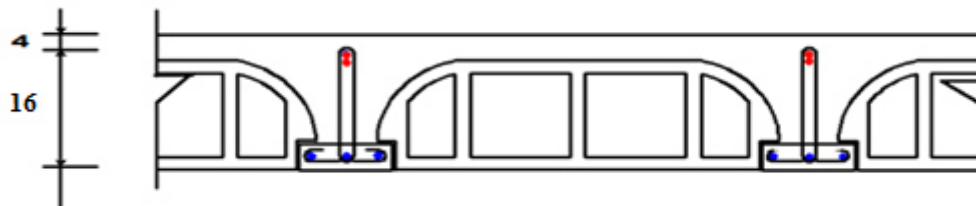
Schéma de ferrailage des poutrelles (aux appuis et en travée).
